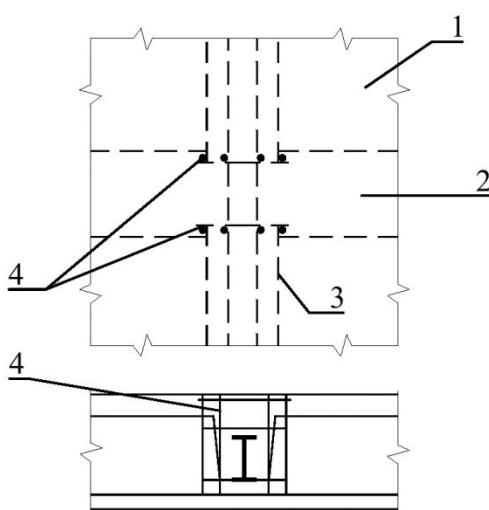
Армирование примыкания второстепенных балок: 1-ж.б. плита, 2-главная балка, 3 - второстепенная балка, 4-арматурные сетки
